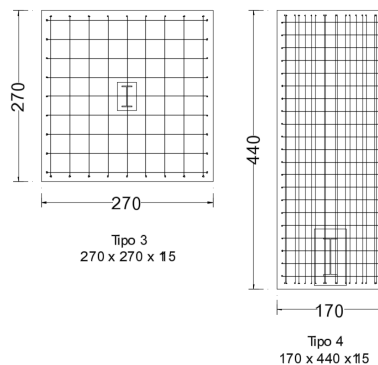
Esquema de las zapatas empleadas en la zona alta
